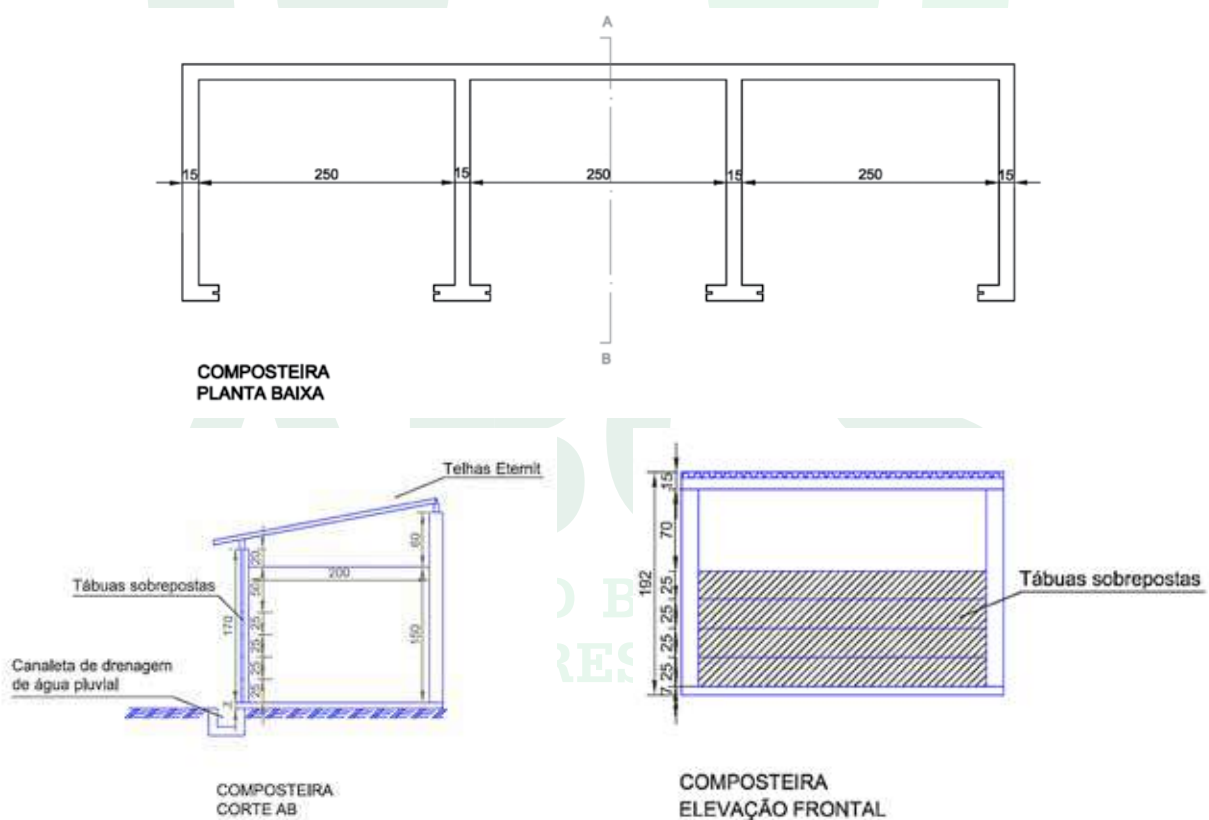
Planta baixa de um conjunto de celas de uma composteira com dimensões de 7,95m x 2,00m, com corte AB, perfil lateral e elevação frontal
